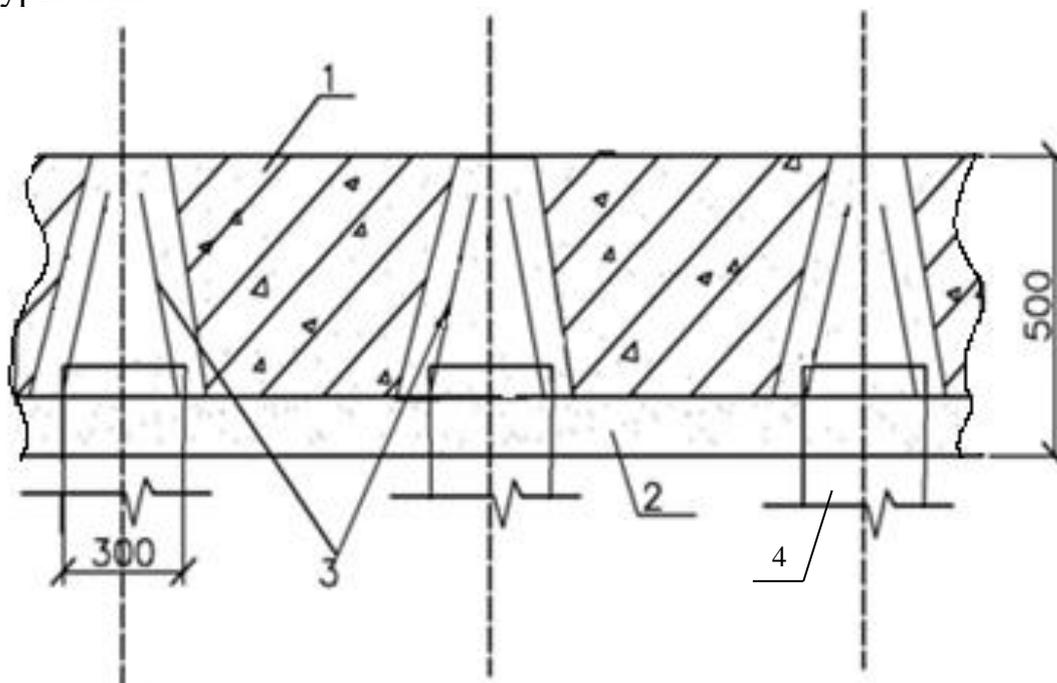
Схема сопряжения балок сборного ростверка со сваями:
